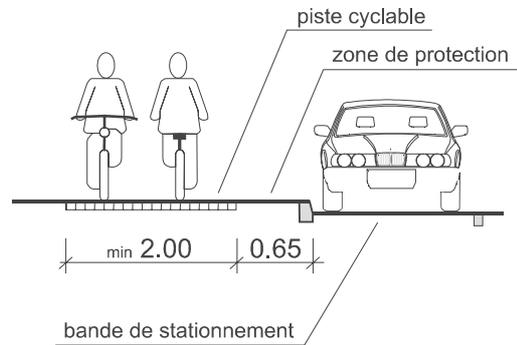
piste cyclable bidirectionnelle stationnement longitudinal
